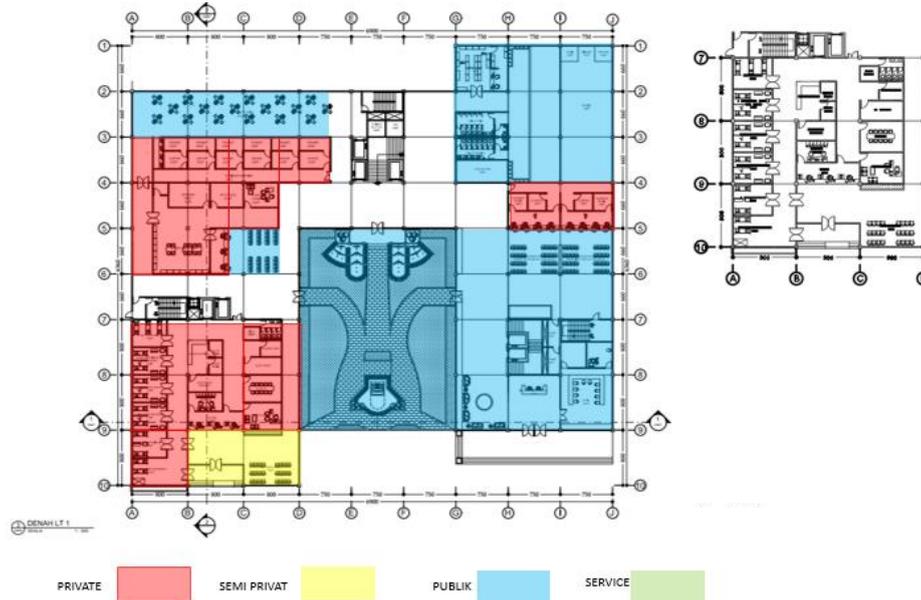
Zonasi Dalam Bangunan lantai Lower Ground
